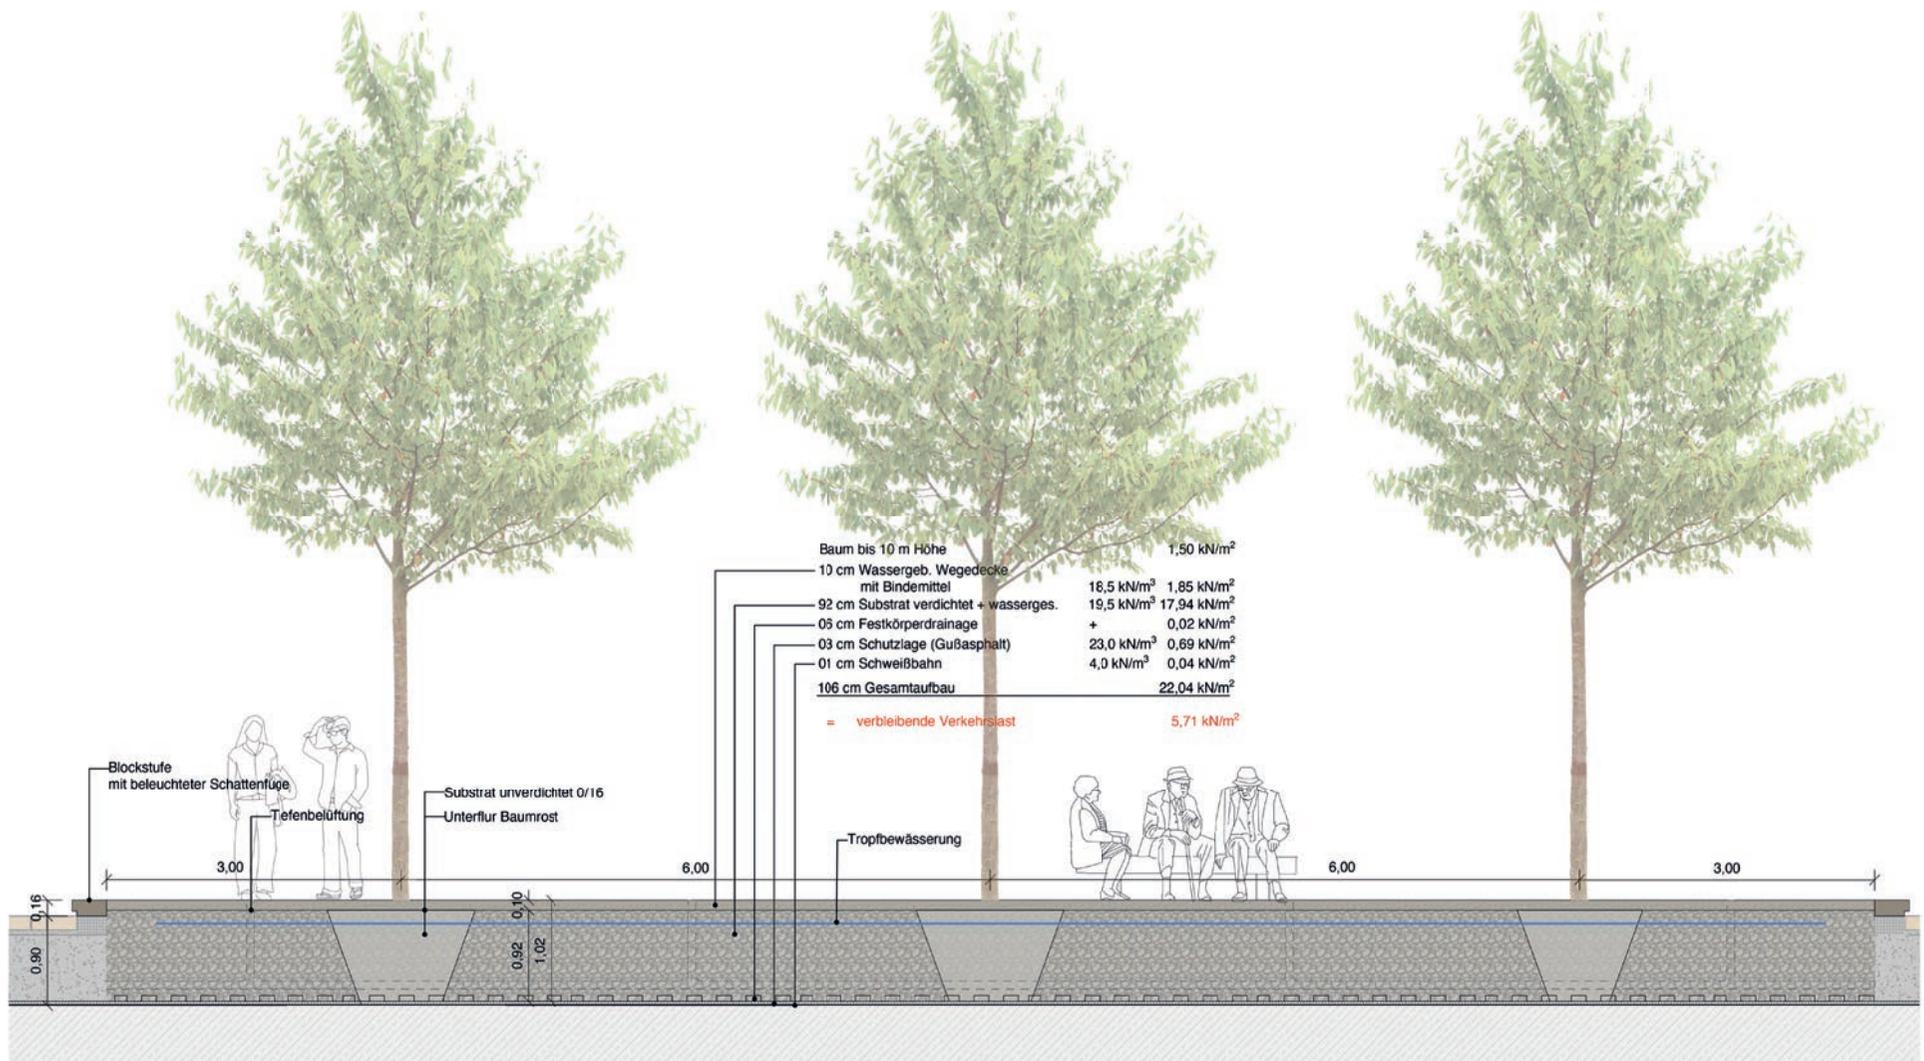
Schnitt A-A der Baumbühne mit Auflasten (o.M.)
